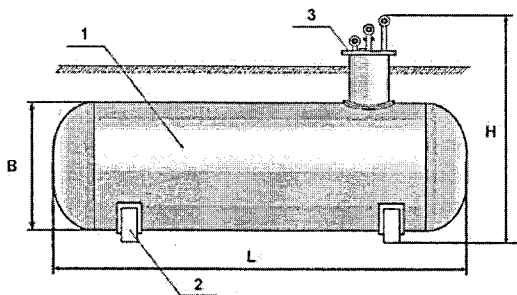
Металевий резервуар: 1 – резервуар, 2 – опора, 3 – кришка люка
